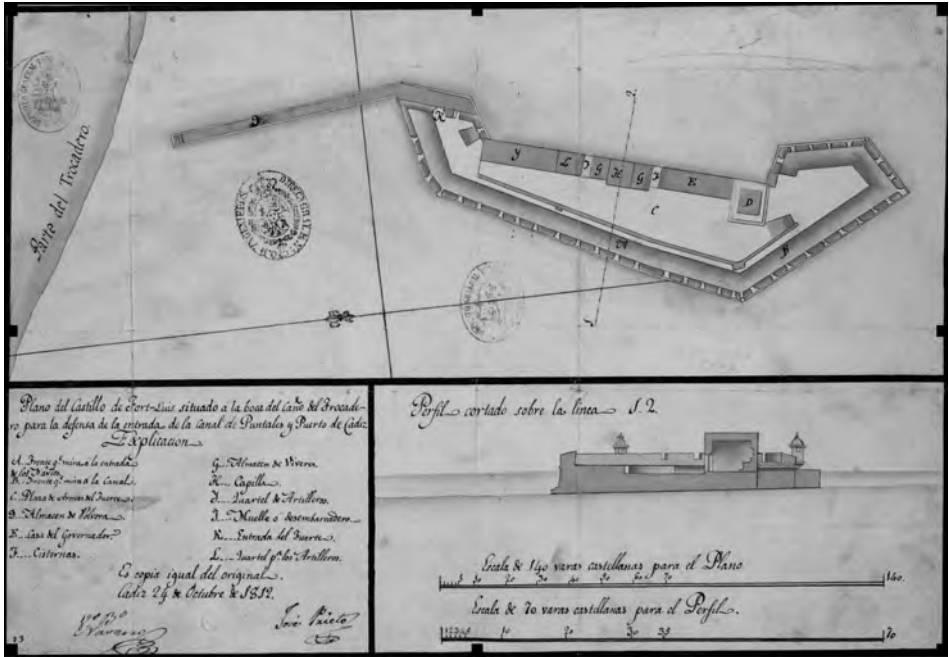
Planta y alzado del fuerte de San Luis. Año 1812
